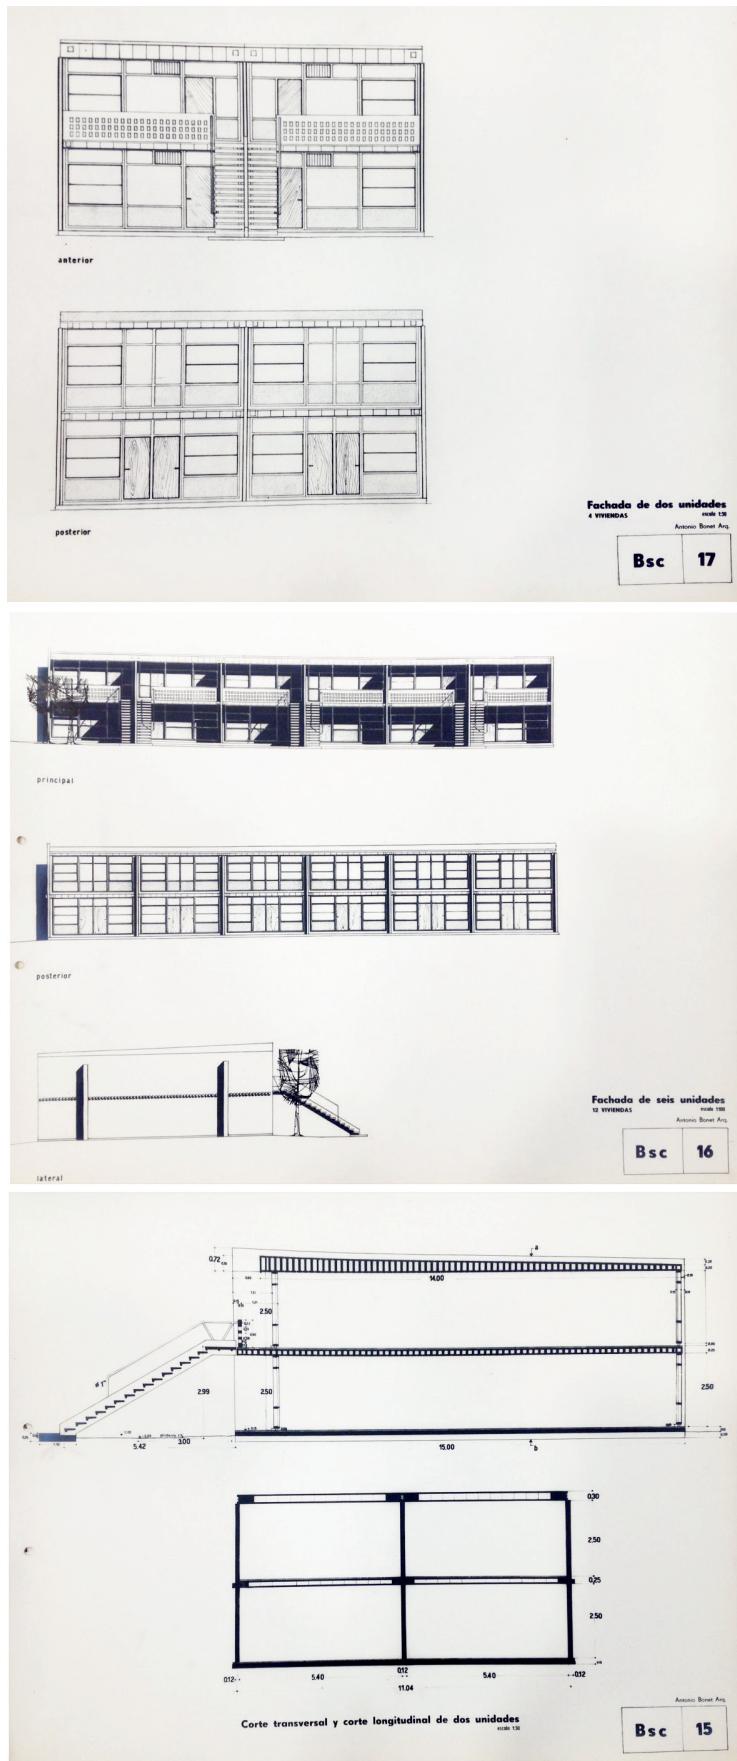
Sistema BSC. 1953-56. Alzados con detalle de fachada, sección longitudinal y sección trasversal.
